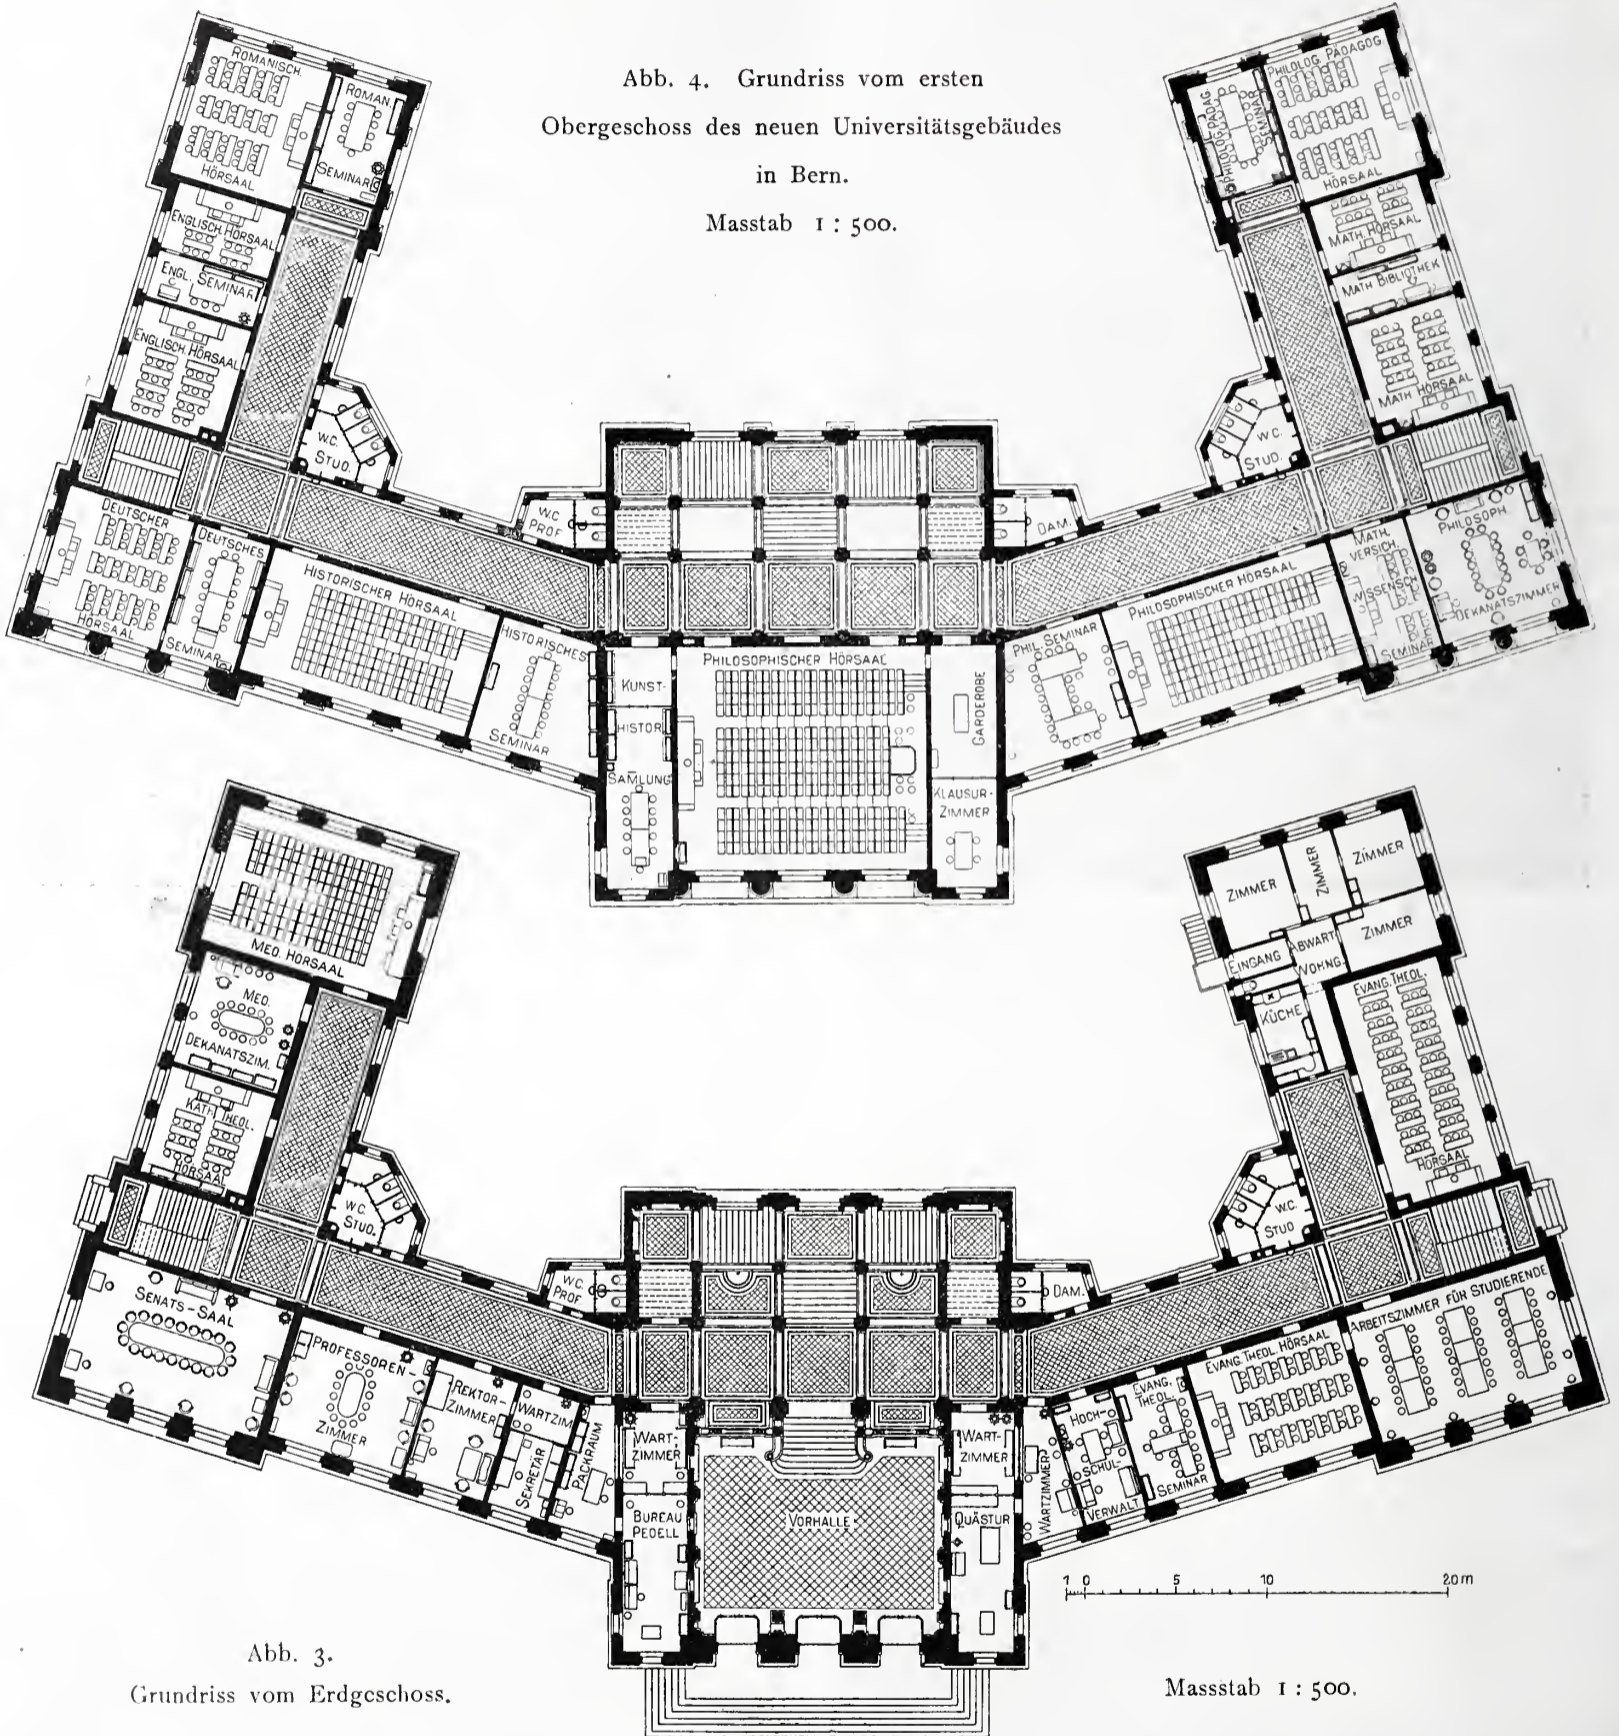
Grundriss vom Erdgeschoss.
